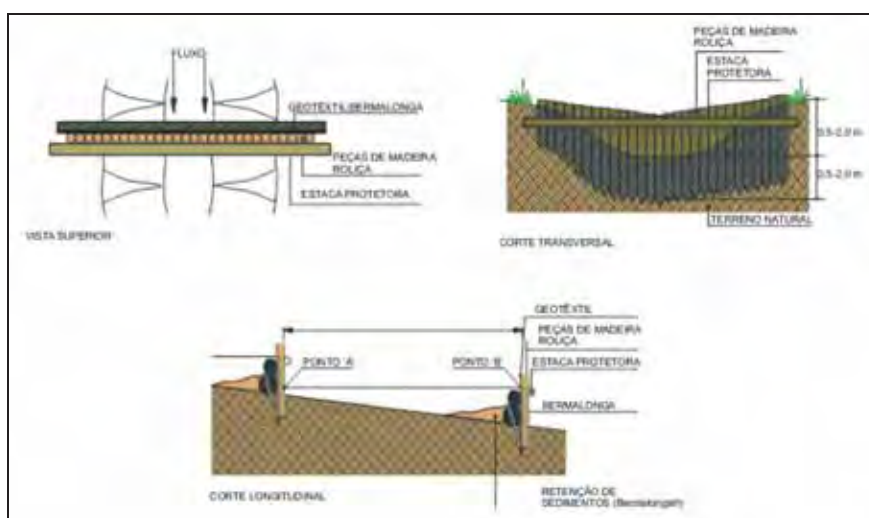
Vista em planta e corte da construção de paliçada de madeira (Fonte: Pereira, 1998 citado por Couto et al., 2010).
